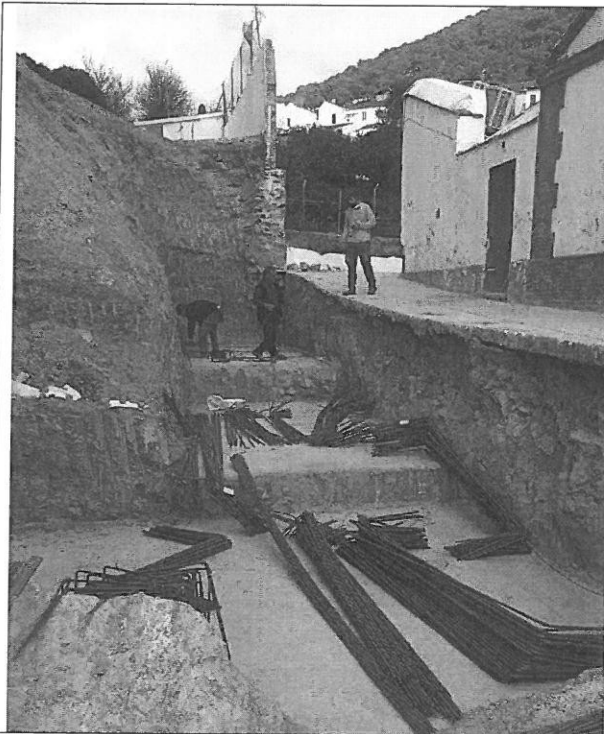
Se procede a colocar la armadura de la zapata de cimentación y el arranque de muro.
